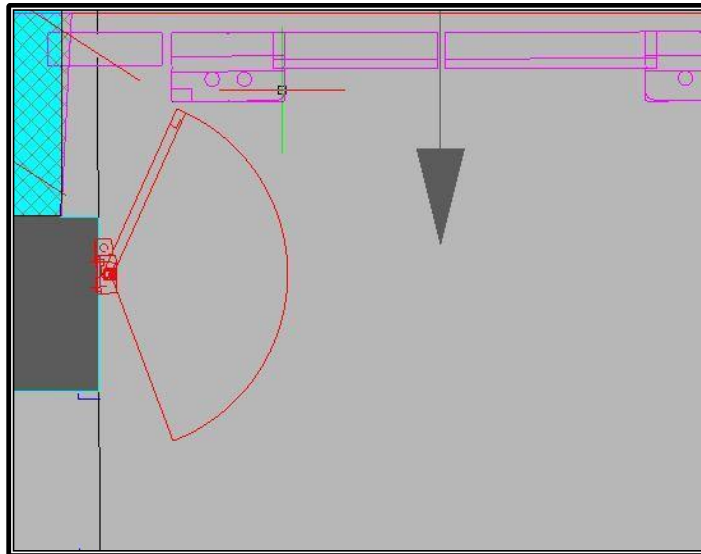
Ejemplo de cierre de andén: Apertura puerta de fin de andén entre la pared y la última puerta deslizante
